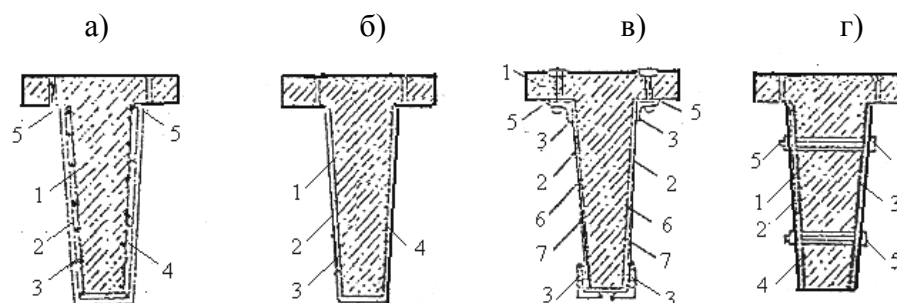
Усиление стенок железобетонных подкрановых балок устройством железобетонной (а) и пластиковой (б) рубашки, стальной обоймы (в) и наклейки листового металла на полимеррастворе (г)
